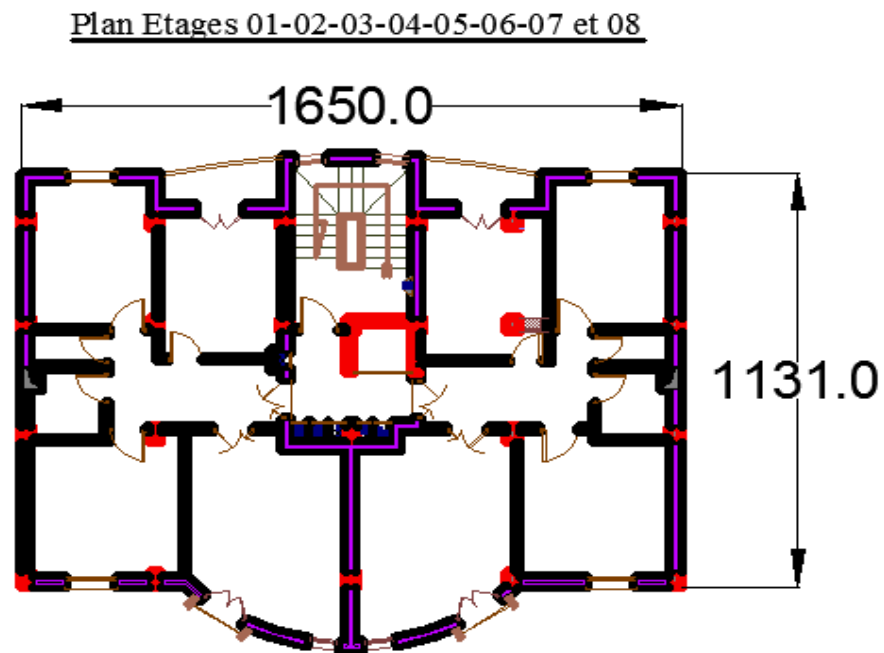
Plan étages 01-02-03-04-05-06-07 et 08.
